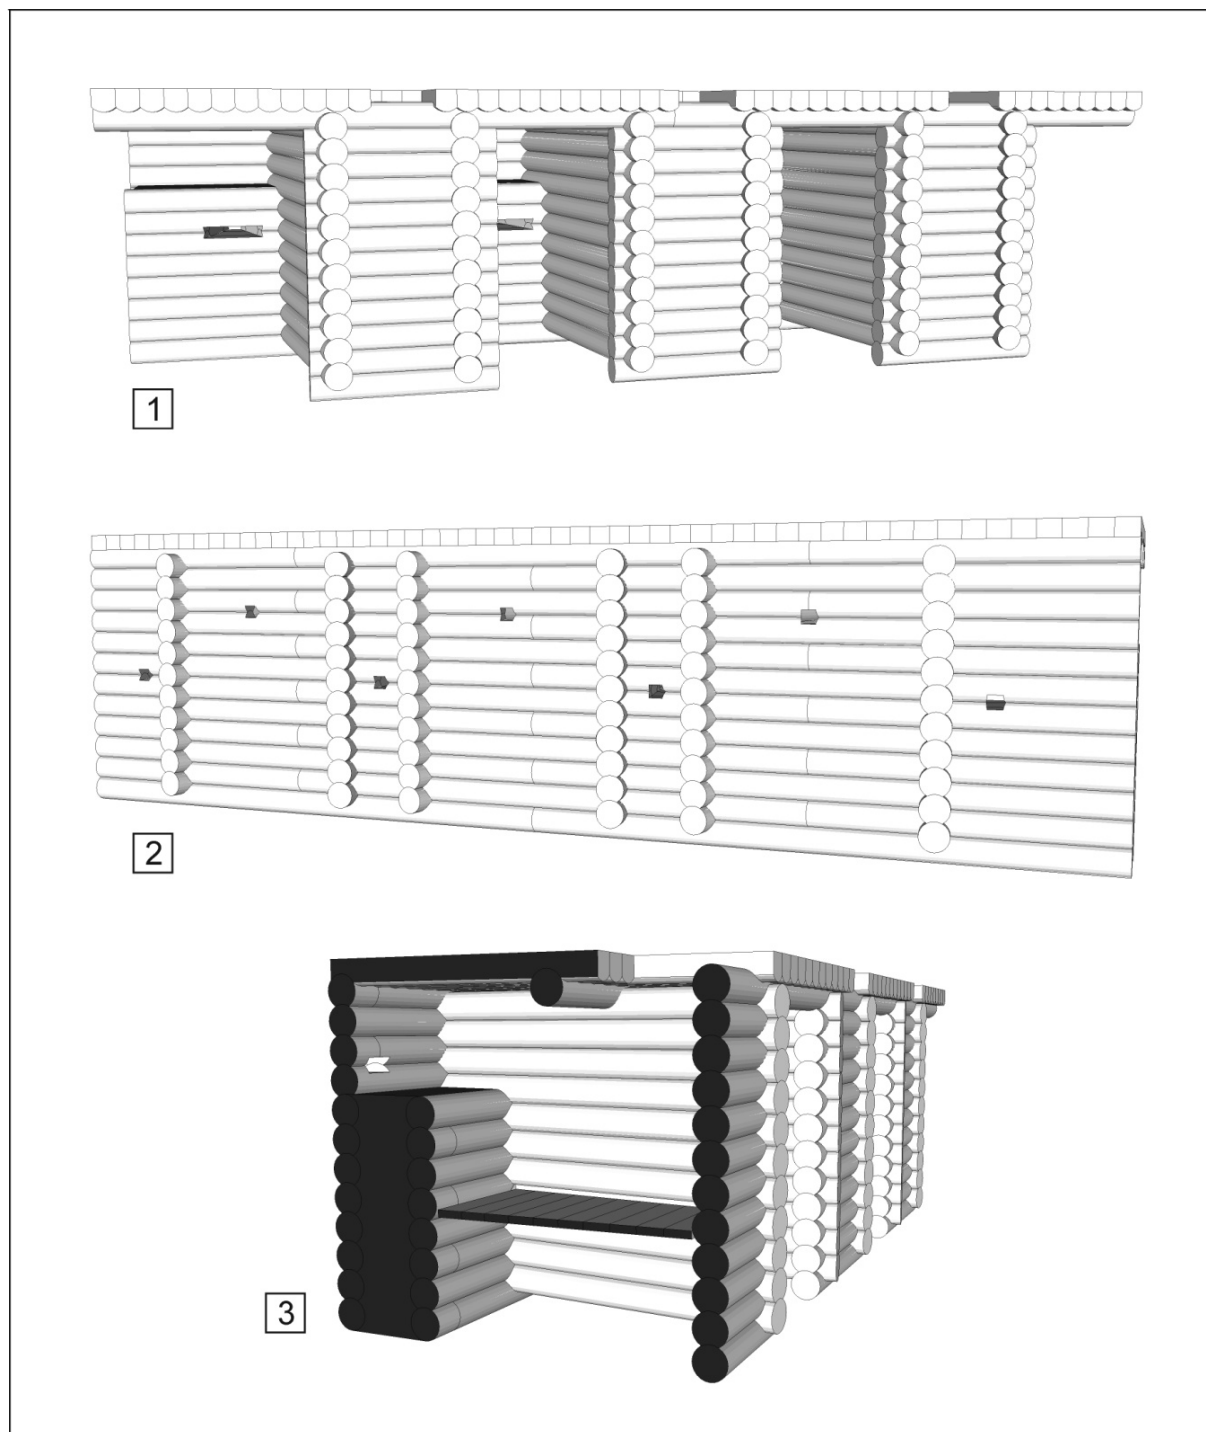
Реконструкция тарасных стен в Олонце по описанию 1670 г.
